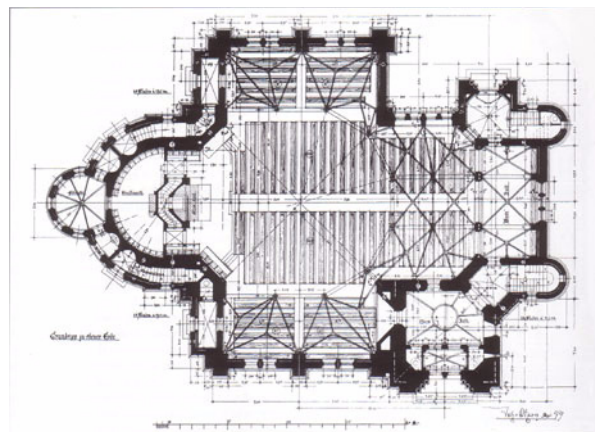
Der von Johannes Otzen unterzeichnete Grundriss der Hauptkirche.
